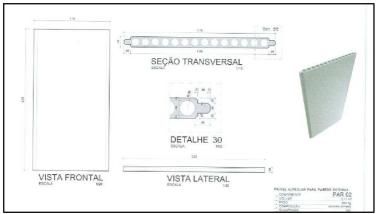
Detalhamento das paredes externas e internas em painel alveolar.
